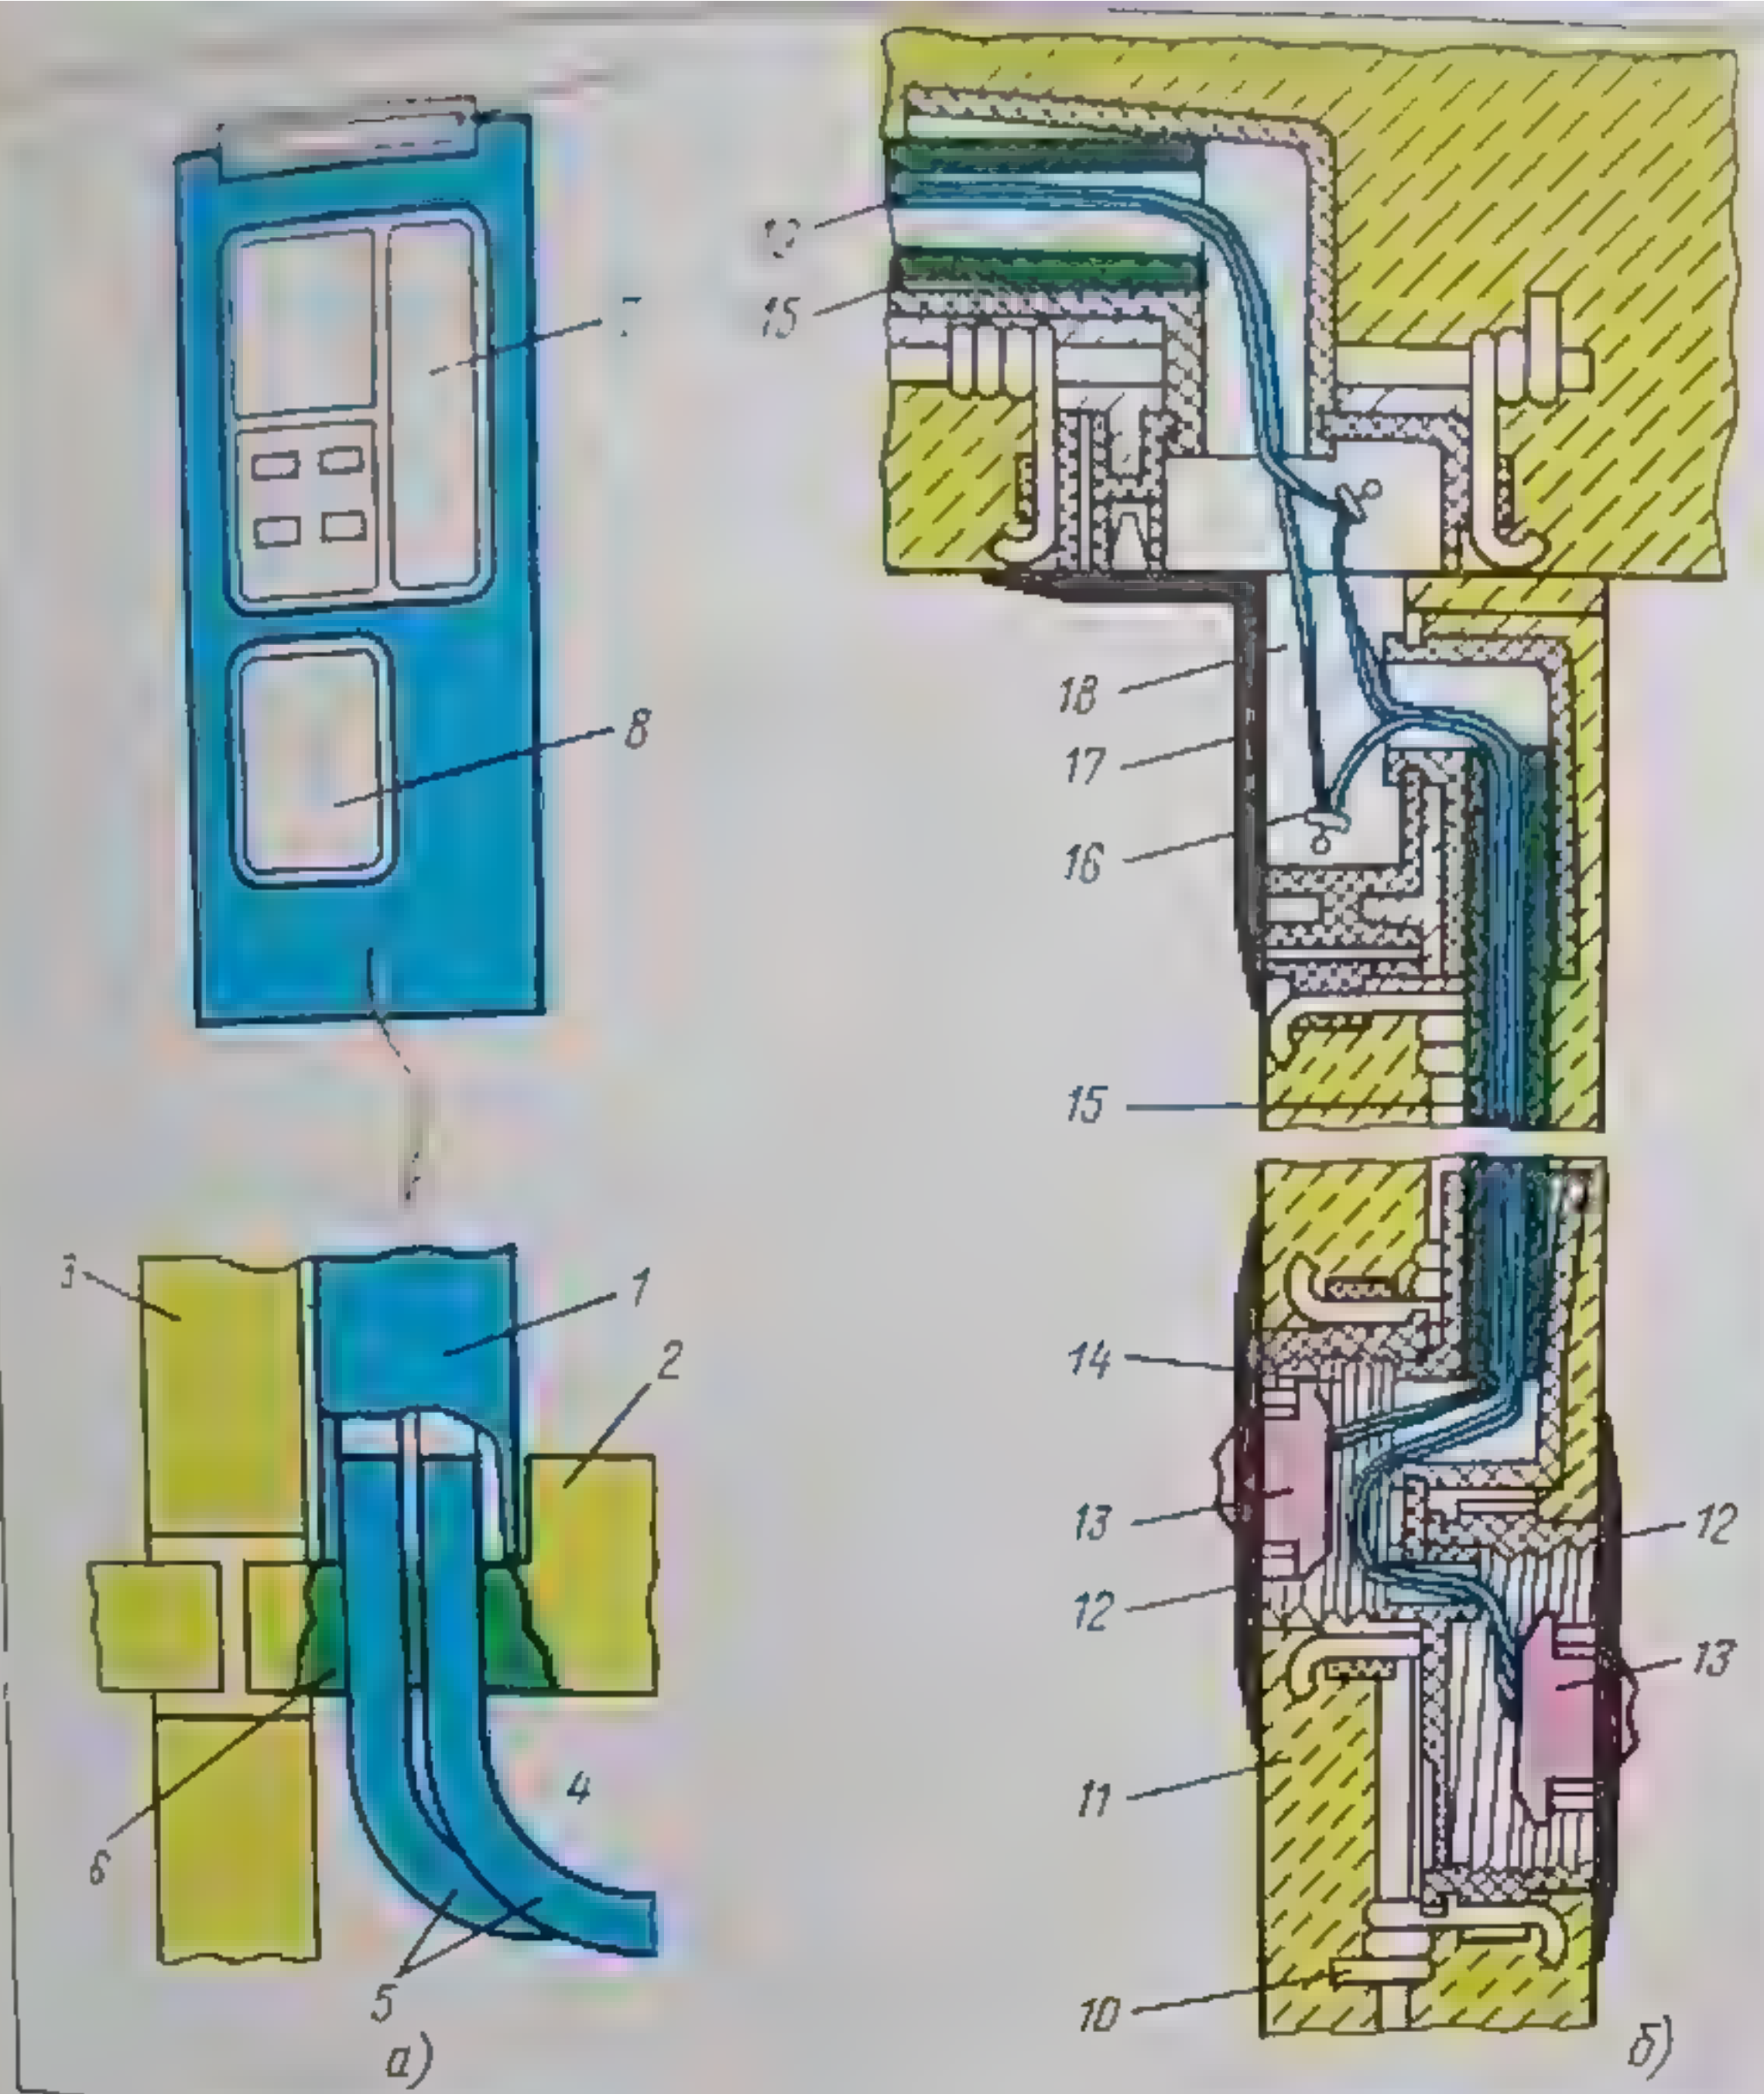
Ввод питающих линий в электроблок и установка в нем электроконструкций (а); фрагмент скрытой проводки в замоноличенных пластмассовых трубах. Узел перехода групповой сети из панели перекрытия в перегородку (б)
